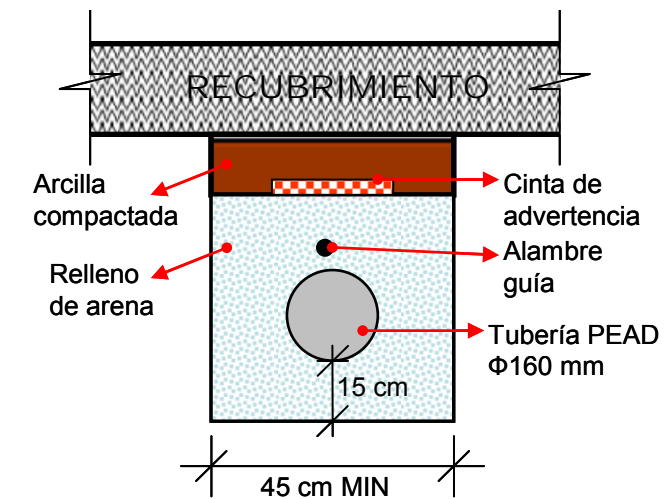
Detalle de zanja tipo y tubería de extracción de gas.
